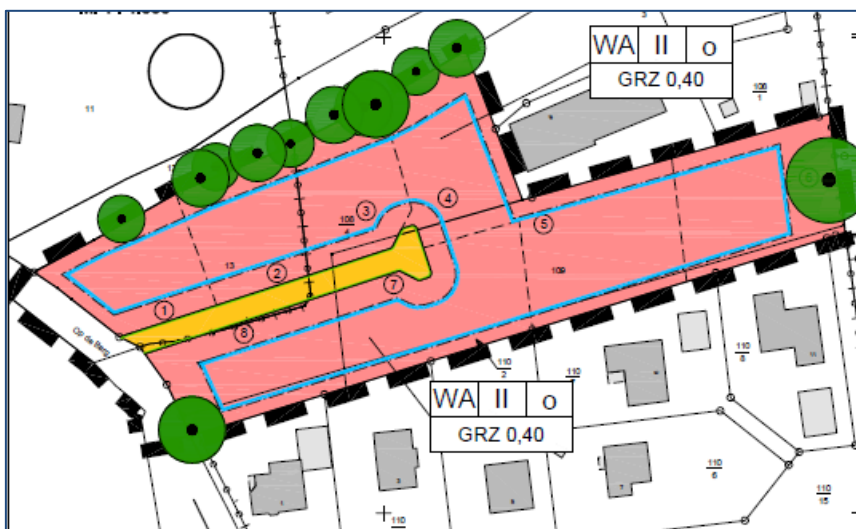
Ausschnitt Planzeichnung Wohngebiet, Zufahrt, Erhalt von Bäumen
